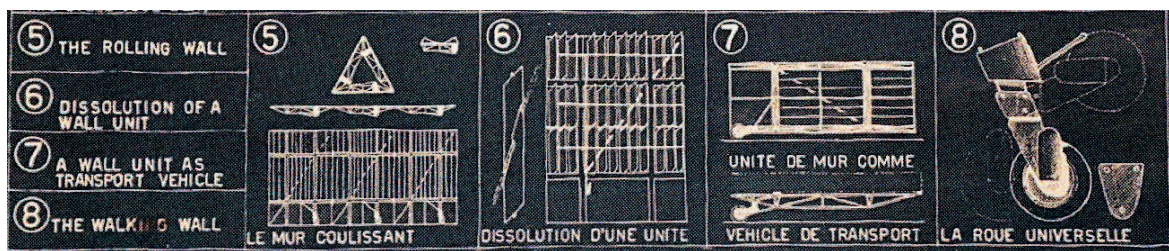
Konrad Wachsmann. *A New Method of Construction*. Lámina 13. *The most Important Details of a new Method of Construction*. 1939. Se describen diferentes elementos del sistema. En el detalle número 5 la denominada *Rolling Wall*. En el detalle número 6 describe como desmantelar una unidad. En el número 7 se describe cómo funciona una unidad de cerramiento como vehículo de transporte y en el número 8 la rueda universal, *the Walking Wall*, el cerramiento andante. En el dibujo se grafían las diferentes posiciones del rodamiento, según se use como tal o como vehículo de transporte.
